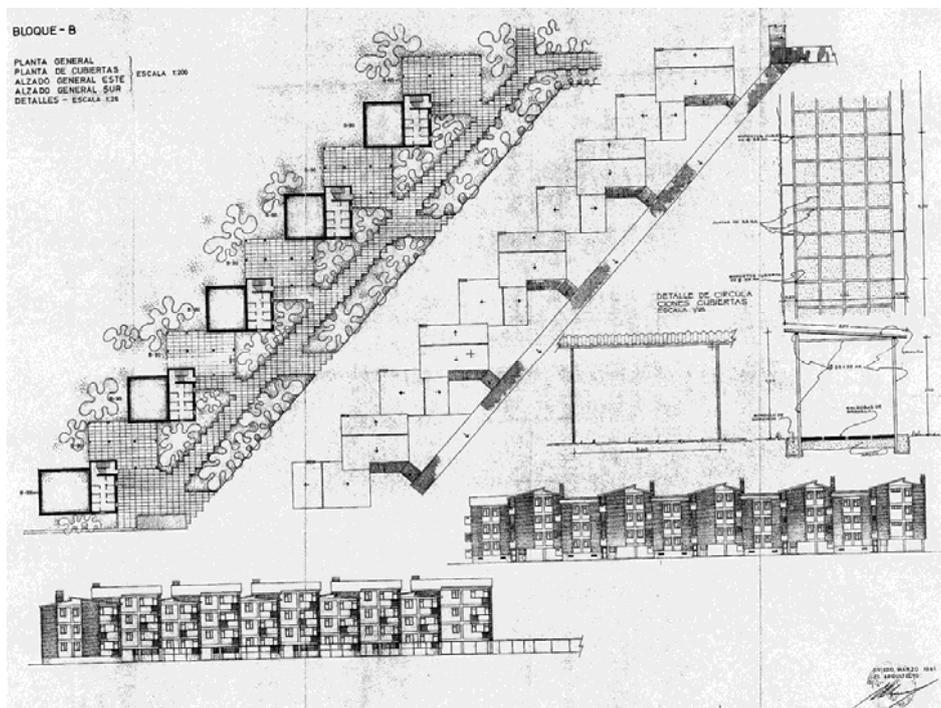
Poblado de Soto de Rey. Bloques tipo B, según proyecto de I. Álvarez Castelao. Plantas y alzados. 1961. Fuente: Archivo de la Central Térmica de Soto de Ribera
